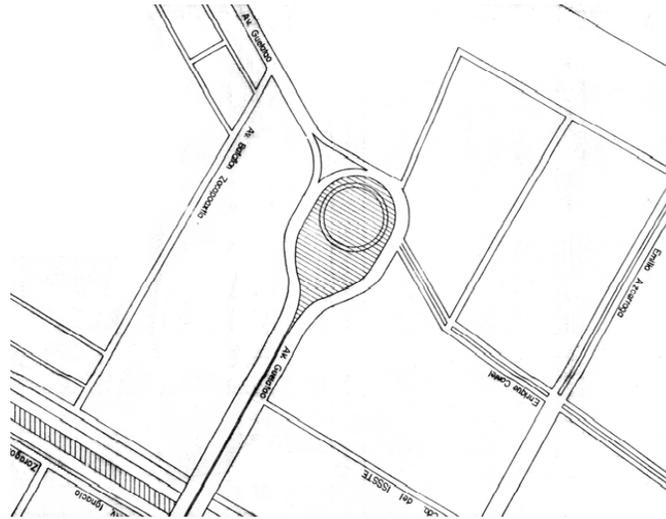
Calzada de Zaragoza, Avenida Guelatao Plano, Salvador Orozco
